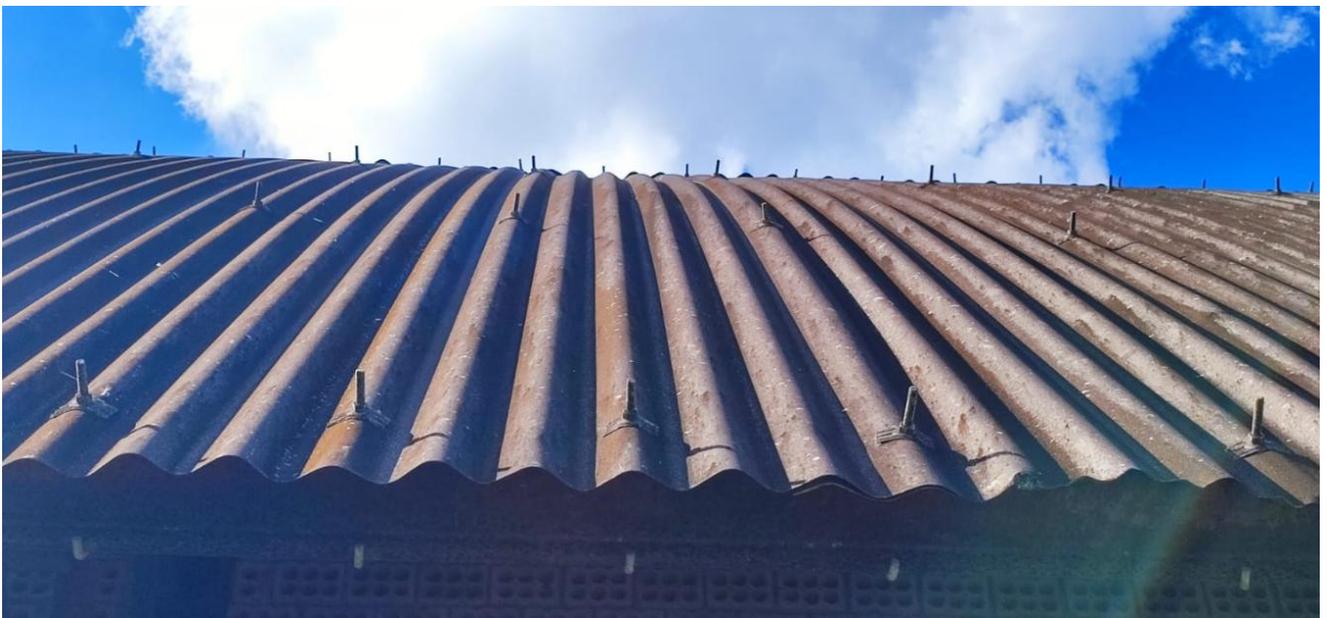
/04 – Vista do sistema de telhamento do Ginásio de Esportes
